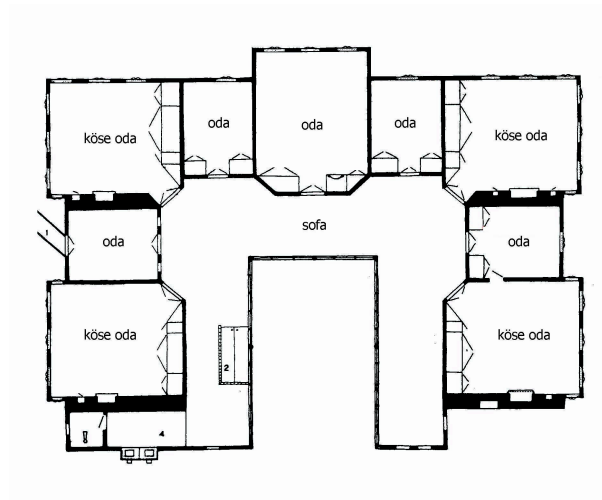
Tekelioğlu evi planı (Bektaş, 1980)
